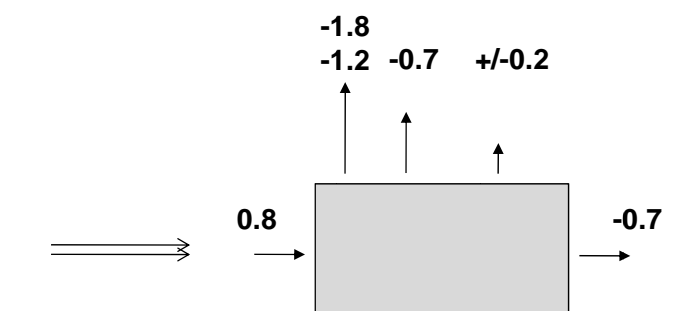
Pressione del vento - coefficienti c_{pe} - sulle superfici di un edificio con tetto piano e spigoli vivi
